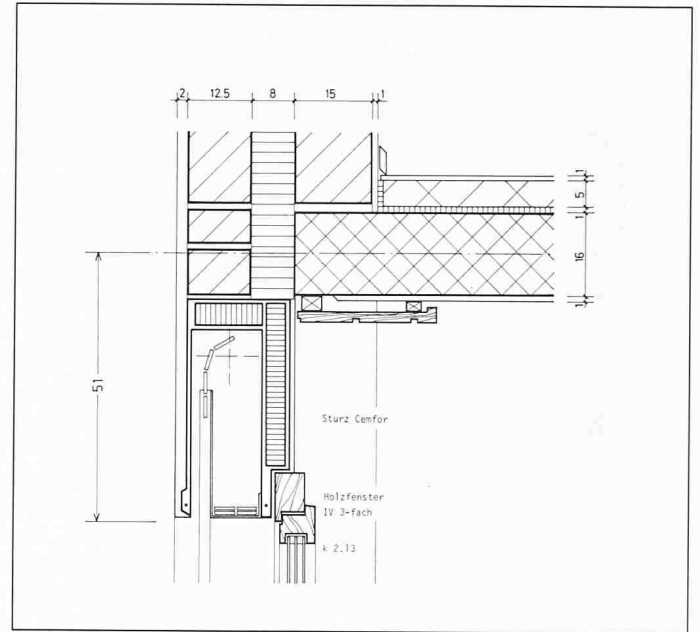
Zwei-Schalenmauerwerk, Detail Sturz mit Faltrolläden
